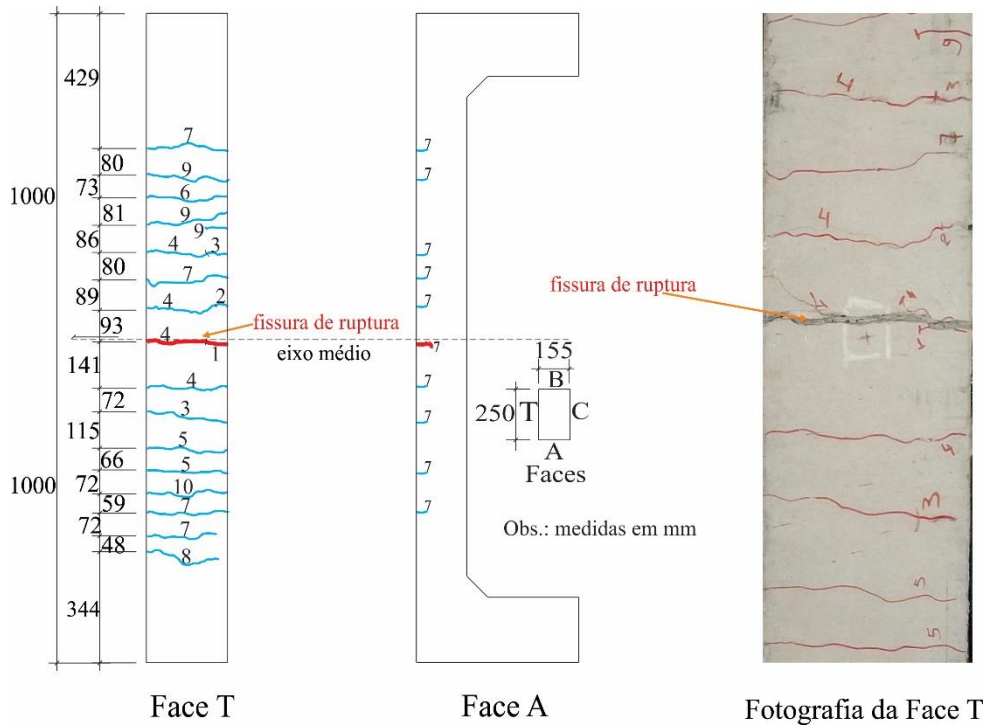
50 - Fissuras nas Faces T e A; Fotografia da face T - pilar de referência (P_{ref})
